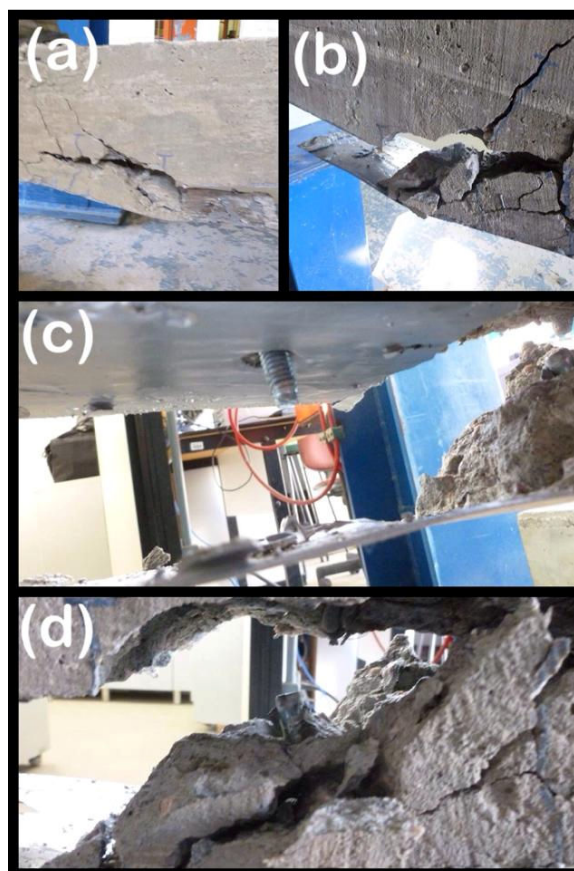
Viga 4 - (a) Ruptura; (b) Fissuras originadas a partir da chapa colada; (c) e (d) Rompimento no parabolt.
